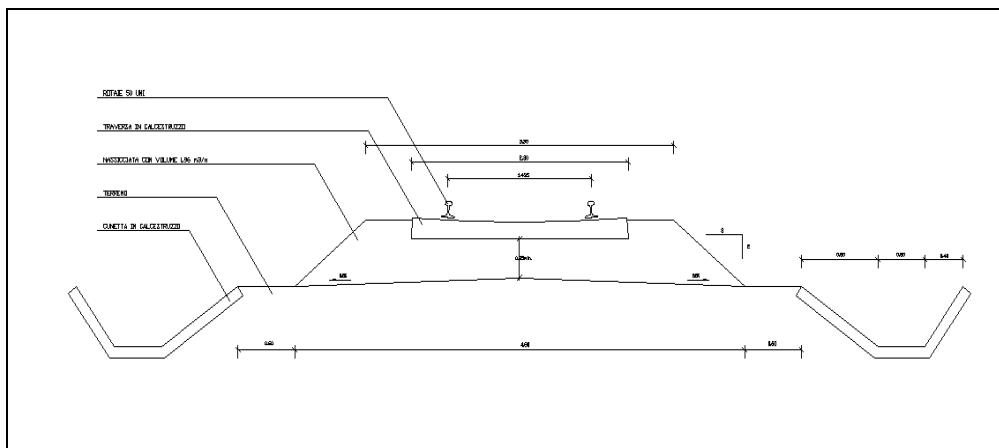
Sezione trasversale rilevato ferroviario con cunette
